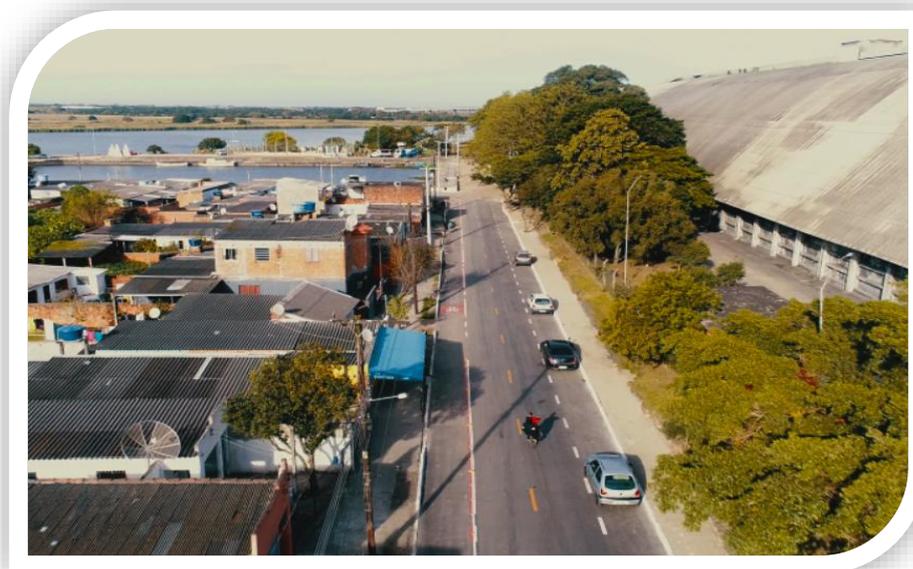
Pavimentação asfáltica da Alberto Rosa.
